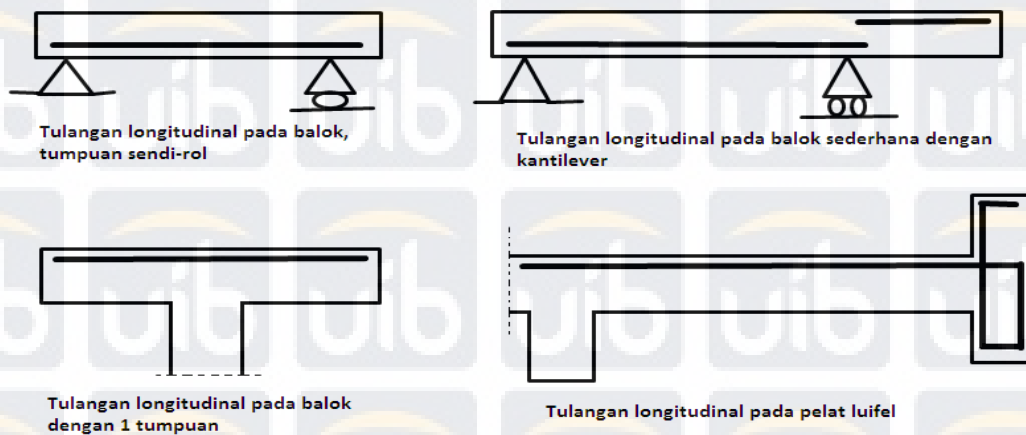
Skema Dasar Hitungan Beton Bertulang
